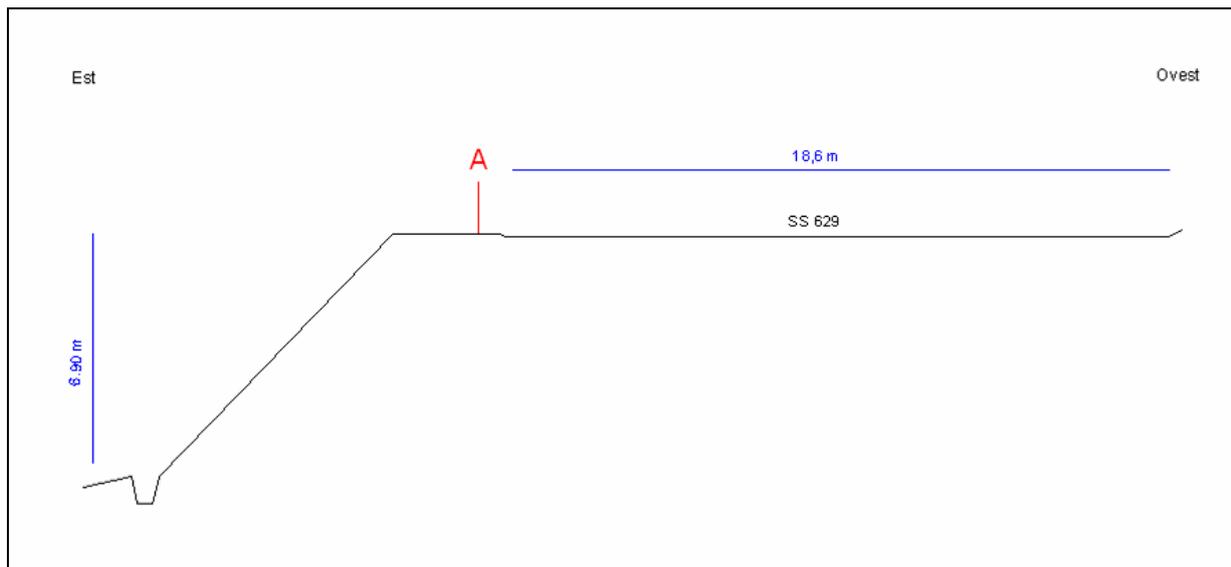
Sezione schematica del tratto stradale di interesse (SS 629)
